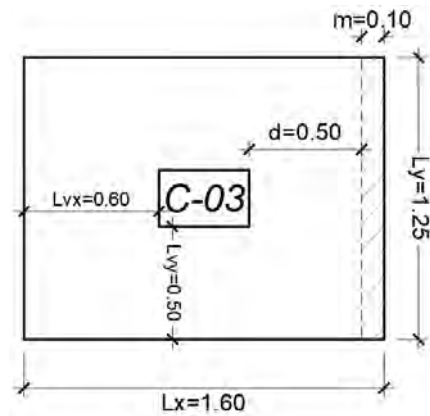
2. Volados en la zapata Z.03 y zona de análisis por corte
